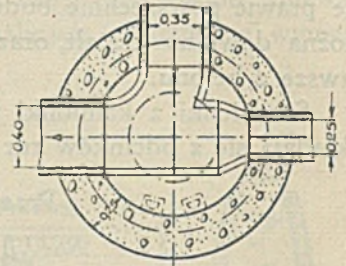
Studzienka żłazowa betonowa zestawiona z gotowych kręgów.
